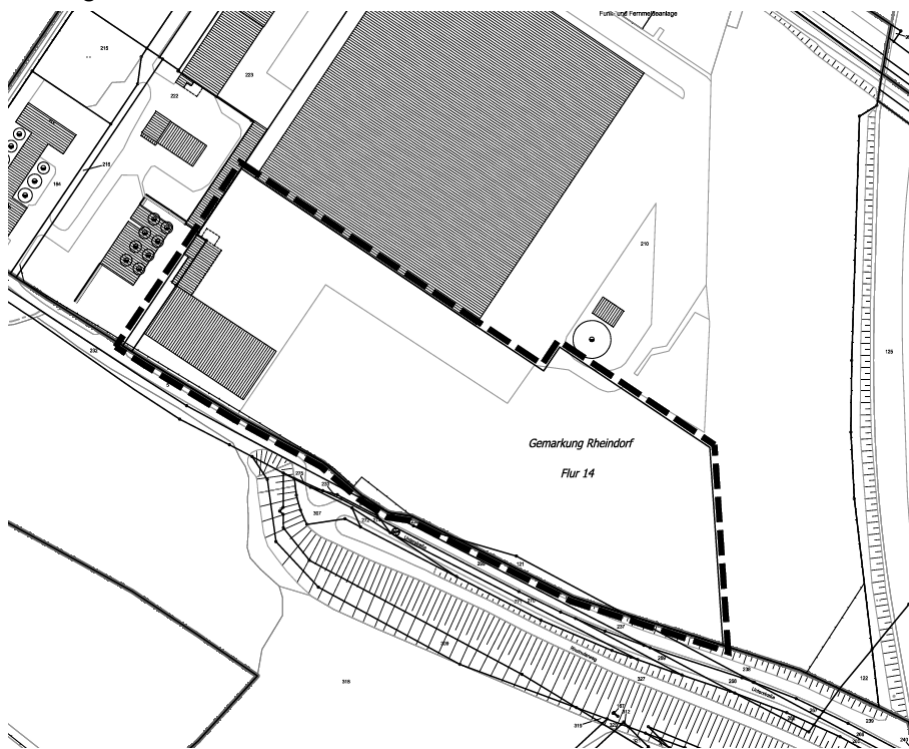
Lageplan des Geltungsbereichs für das Bebauungsverfahren V 34/I „Gewerbefläche Hitdorf-Ost/Wiesenstraße“
